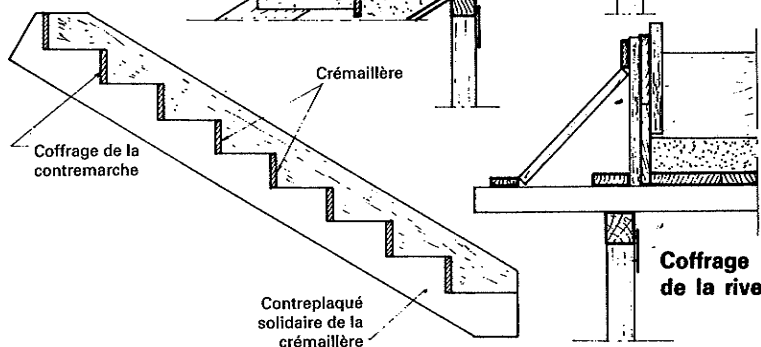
Coffrage de la joue (planche découpée en crémaillère et contreplaqué servant de coffrage de la rive).
